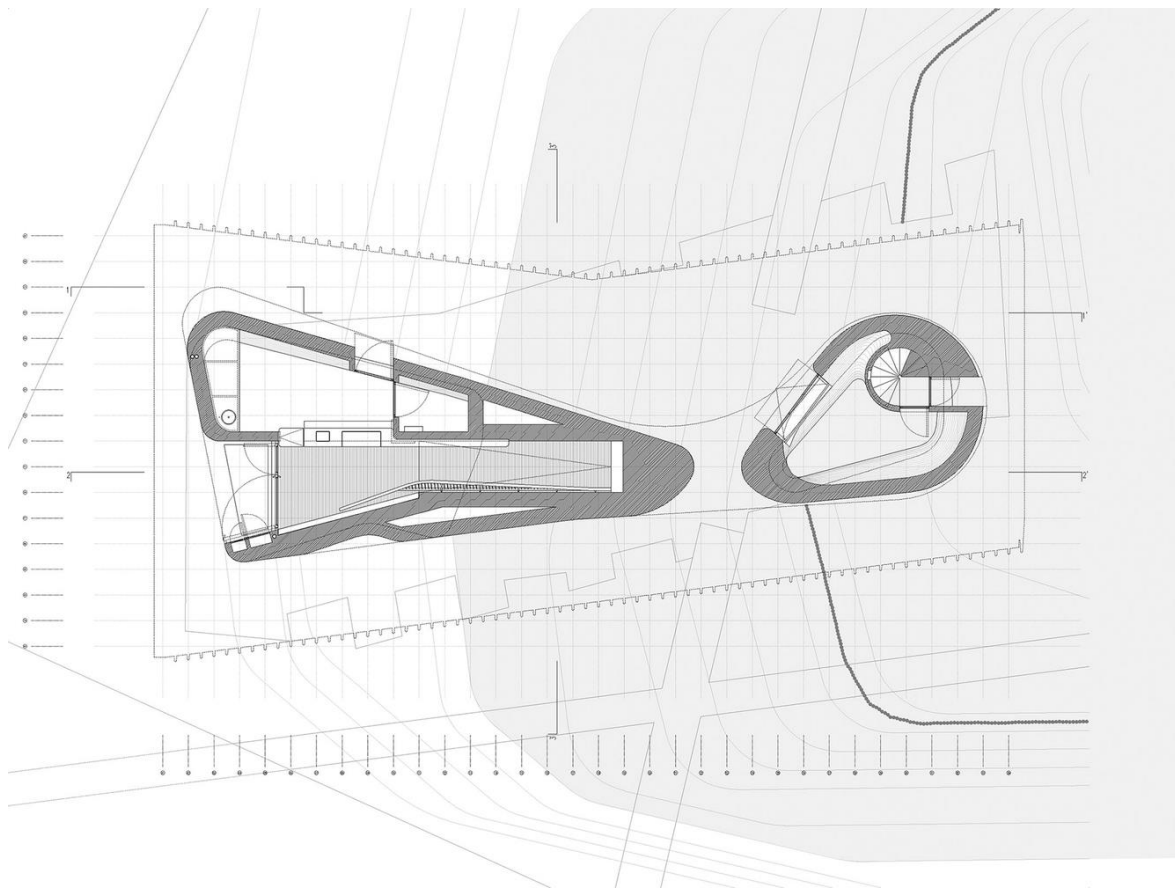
| Planta Térrea Observatório, Machado Costa (Archdaily, 2017)
